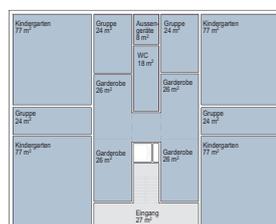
Grundrisse Erdgeschoss und 1./2. Obergeschoss
